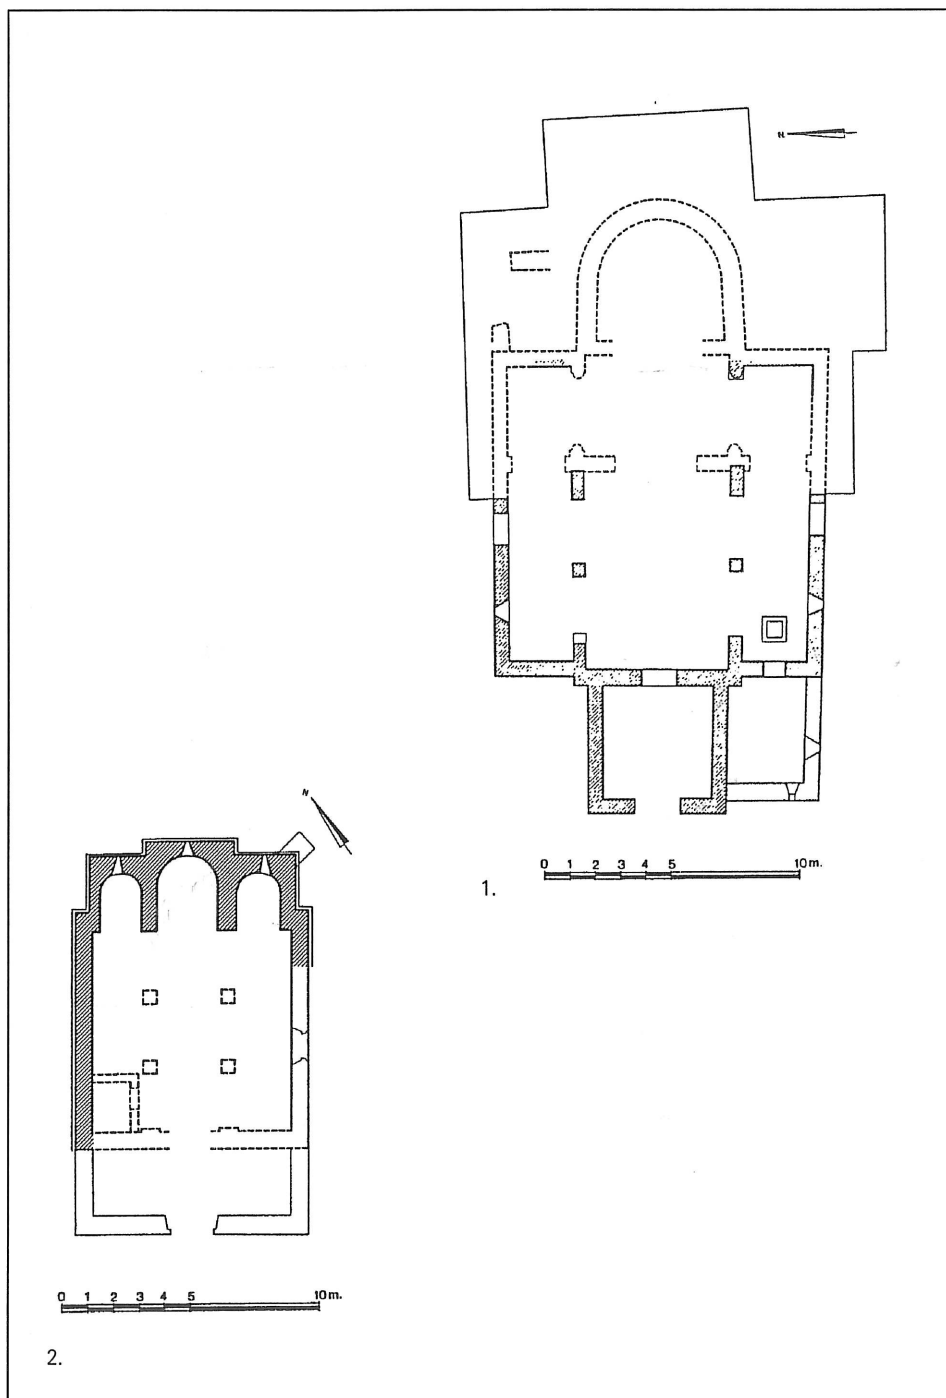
1. Santianes de Pravia (Asturias). Planta (según: J. Menéndez Pidal). 2. Santa María de Mixós (Orense). Planta (según: Lorenzo Fernández)
